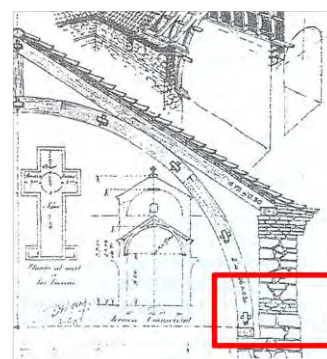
posición de los mechinales en un corte constructivo de cubierta.
